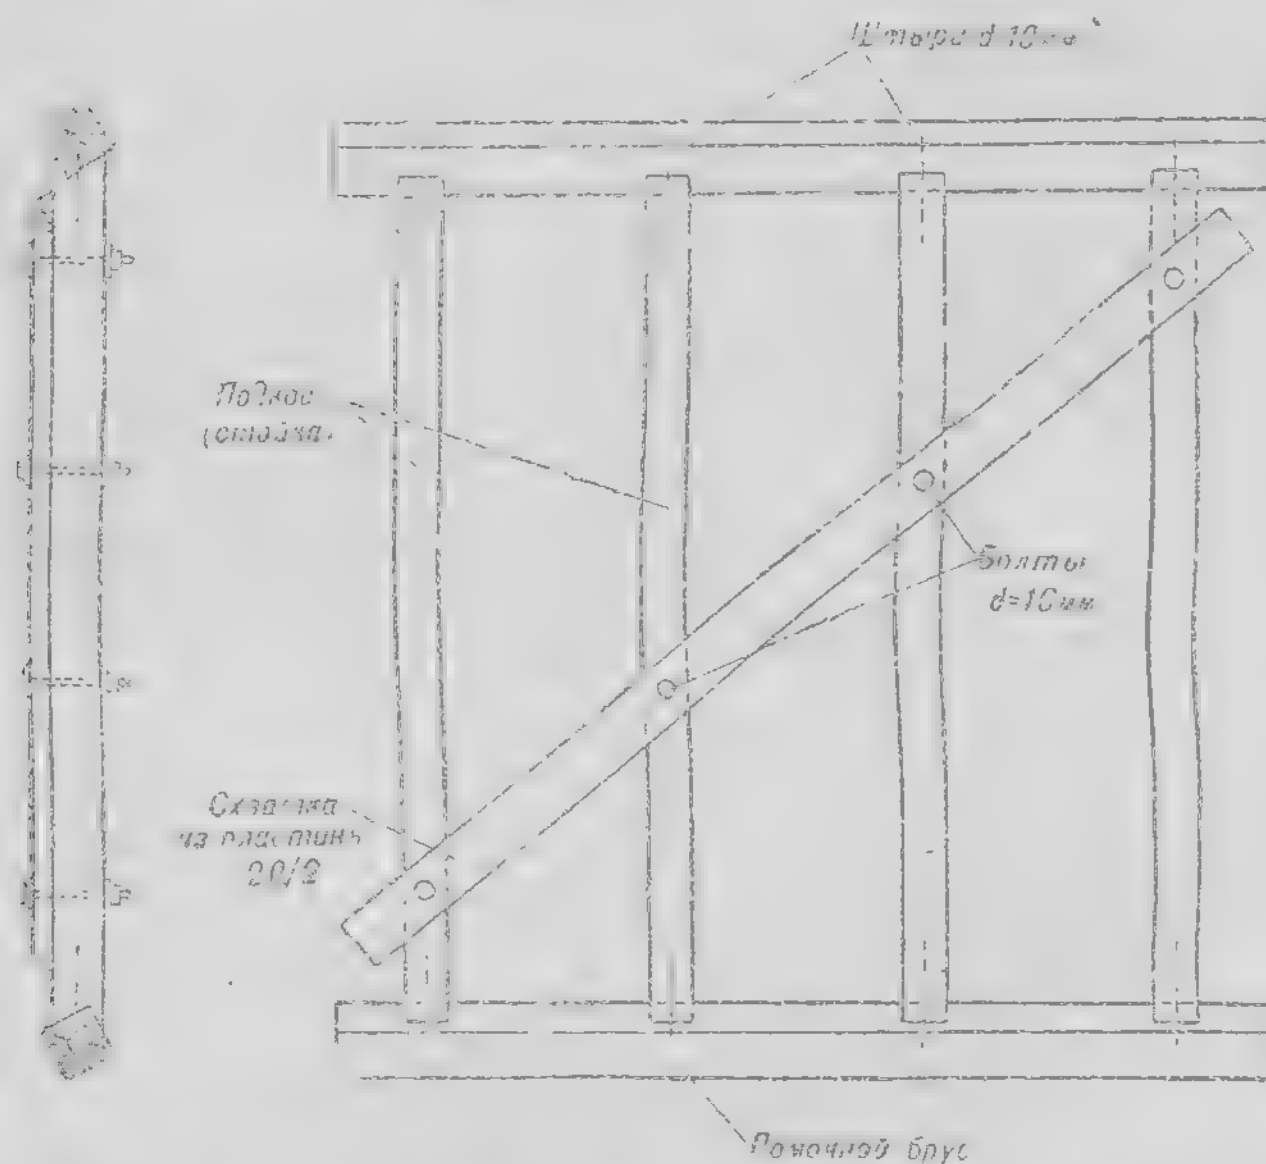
Конструкция подкосной рамы при установке под углом 30° .
